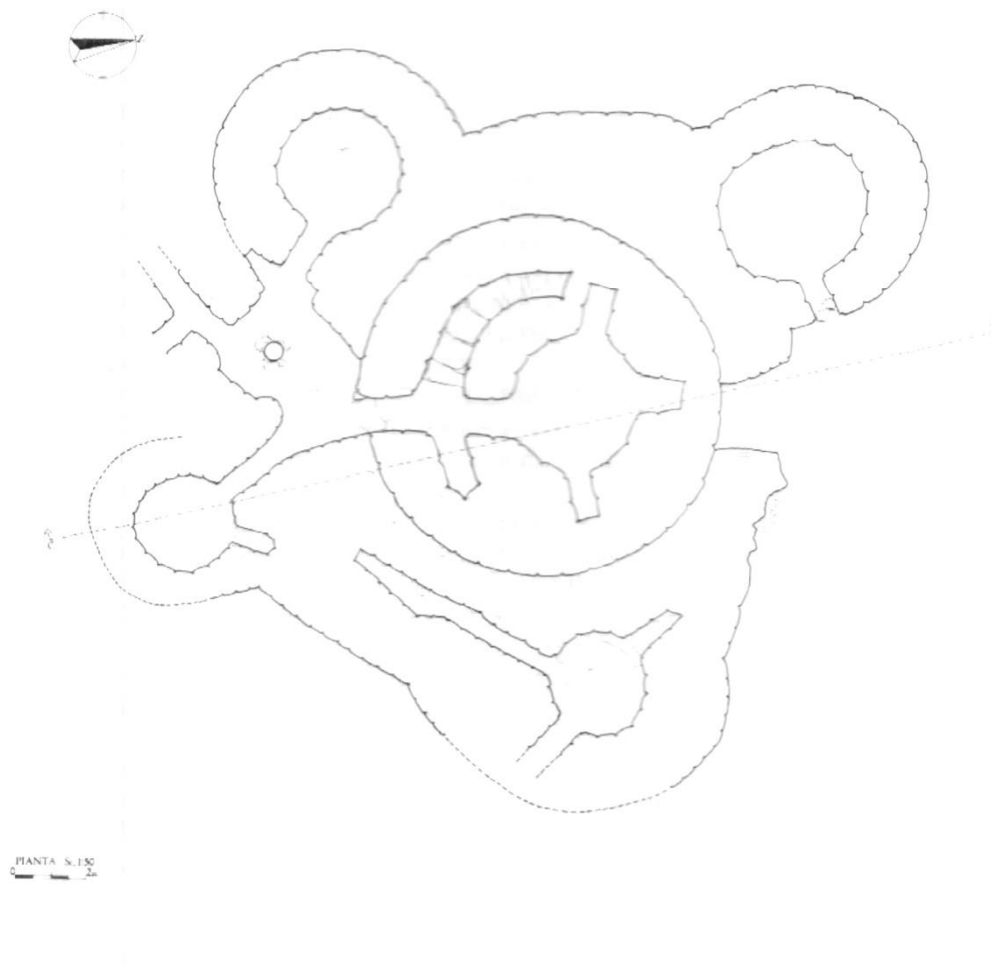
Nuraghe San Pietro: planimetria generale del contesto (da Fadda 1992, Tav. III).
